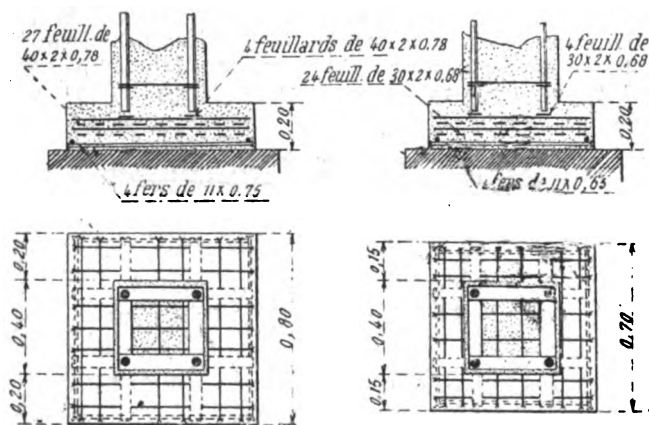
et 5. — Semelles des poteaux des poutres intermédiaires.
